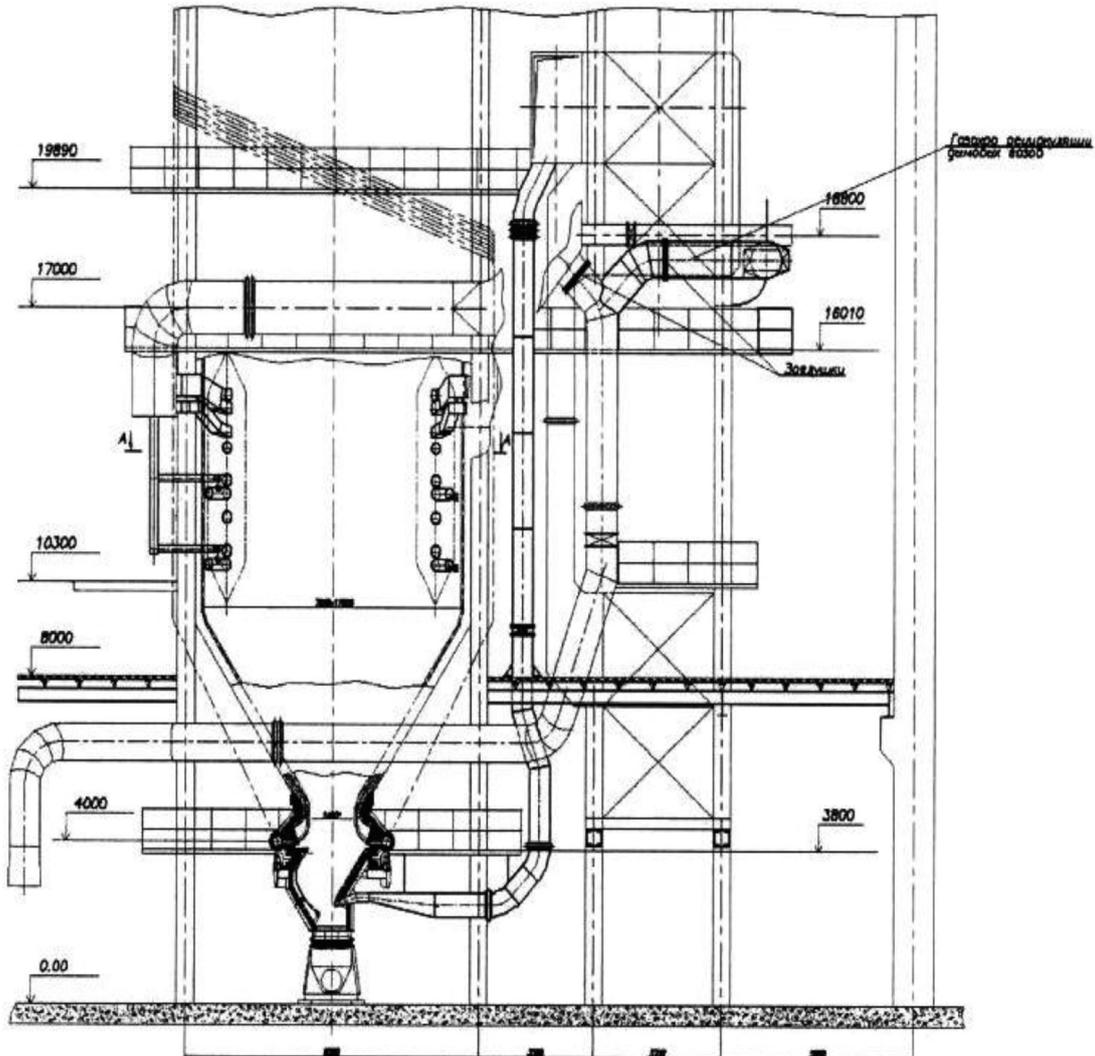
Продольный разрез топочной камеры котлоагрегата ПК-10
